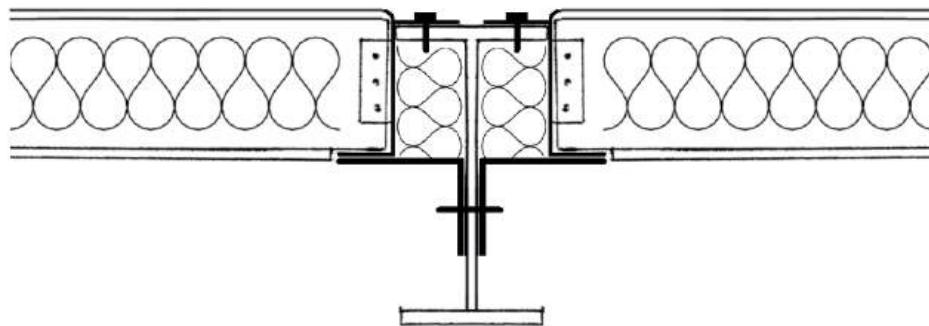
Utilisation d'une cassette isolée préfabriquée pour toiture ou plancher [31]
